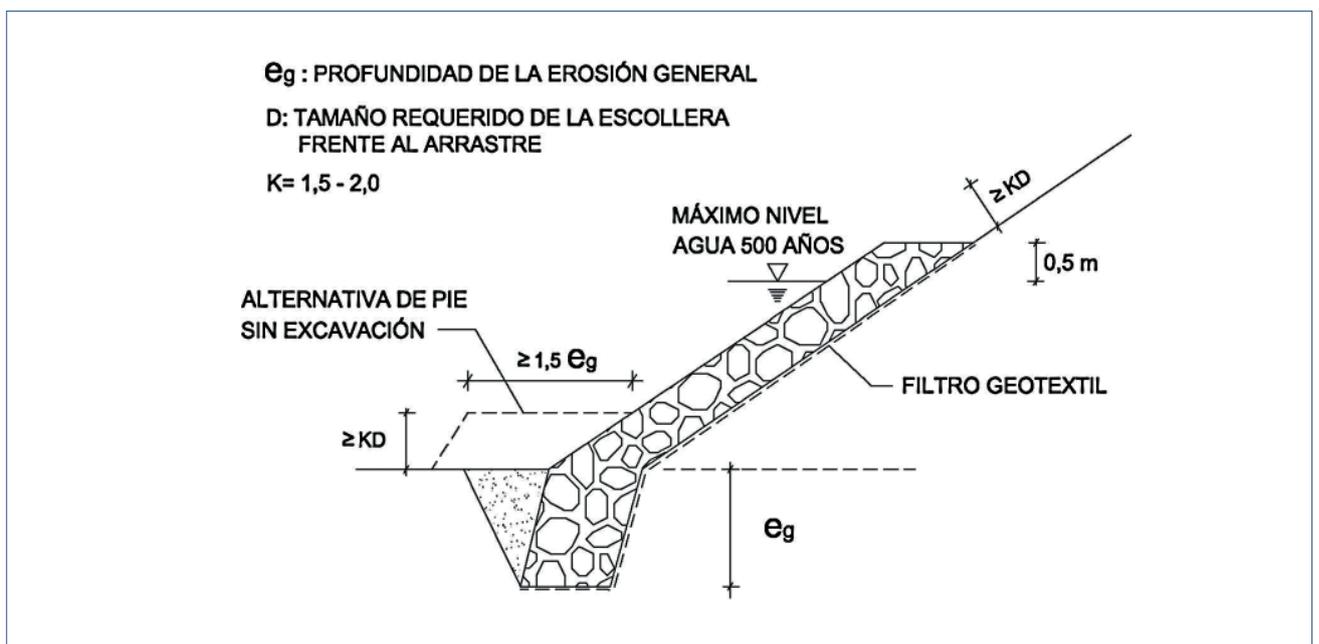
Sección tipo de recubrimiento de escollera (A3)
